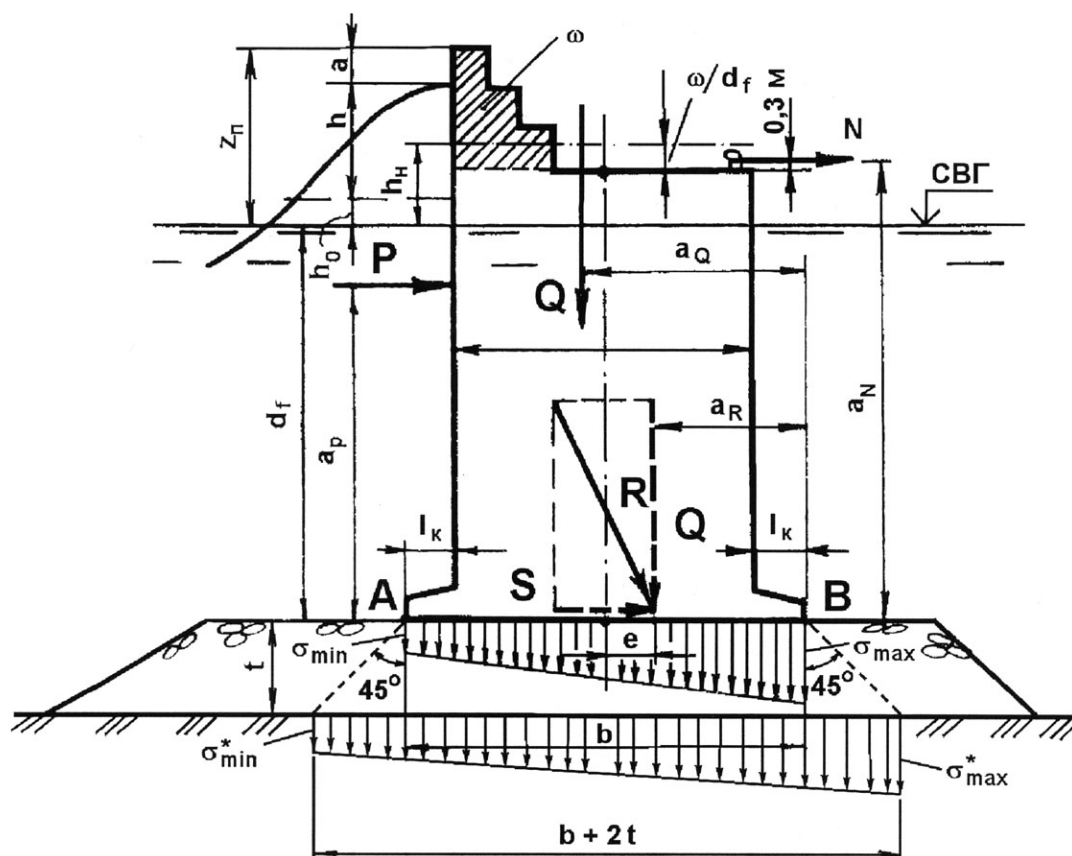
Расчетная схема к определению размеров поперечного сечения сооружения
